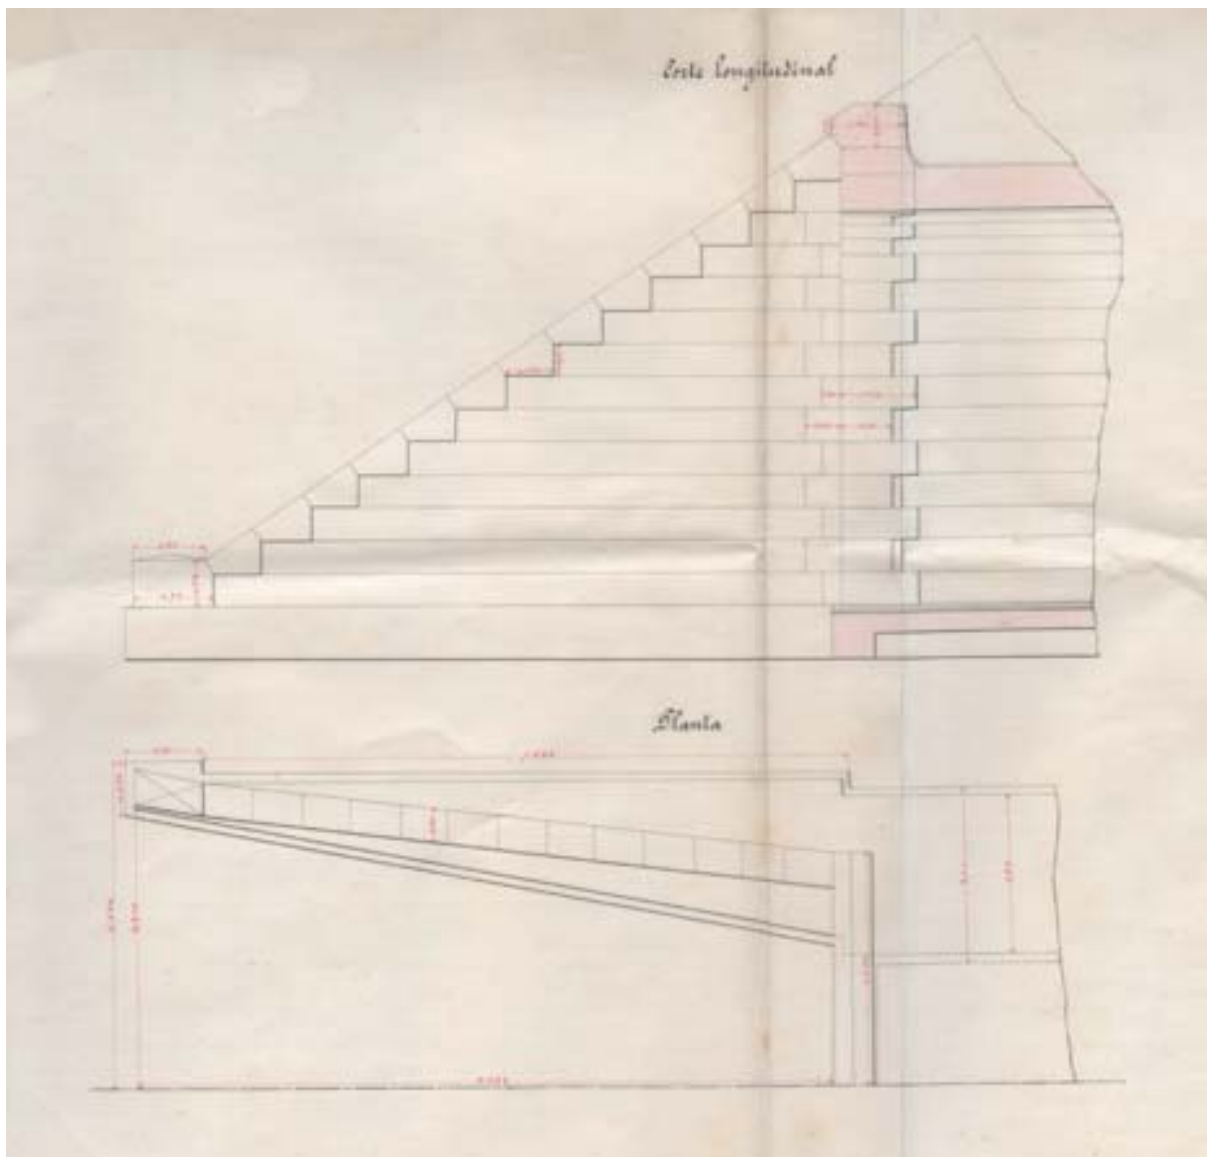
Planta e corte longitudinal do pontão (fonte: Arquivo Histórico do Instituto da Mobilidade e dos Transportes Terrestres)
